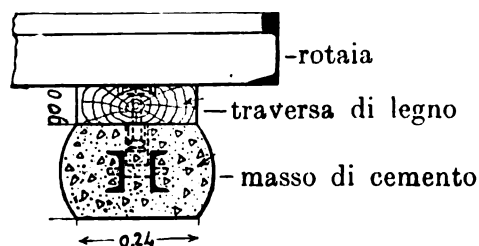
Traversa Kimball. (Sezione trasversale).
